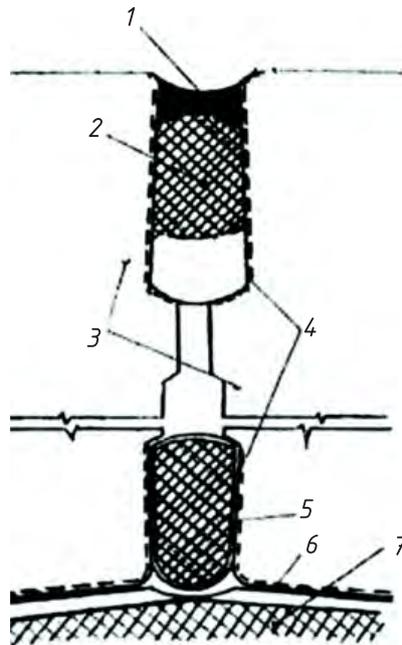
Заделка вертикального закрытого стыка: 1 — вулканизирующийся герметик или герметизирующая мастика; 2 — «Вилатерм» или упругий шнур «Гернит», установленный «насухо»; 3 — панели наружной стены; 4 — поверхности, покрытые грунтовочным составом; 5 — «Вилатерм» или упругий шнур «Гернит», установленный на клею; 6 — воздухозащитная лента на клею; 7 — утепляющий вкладыш
